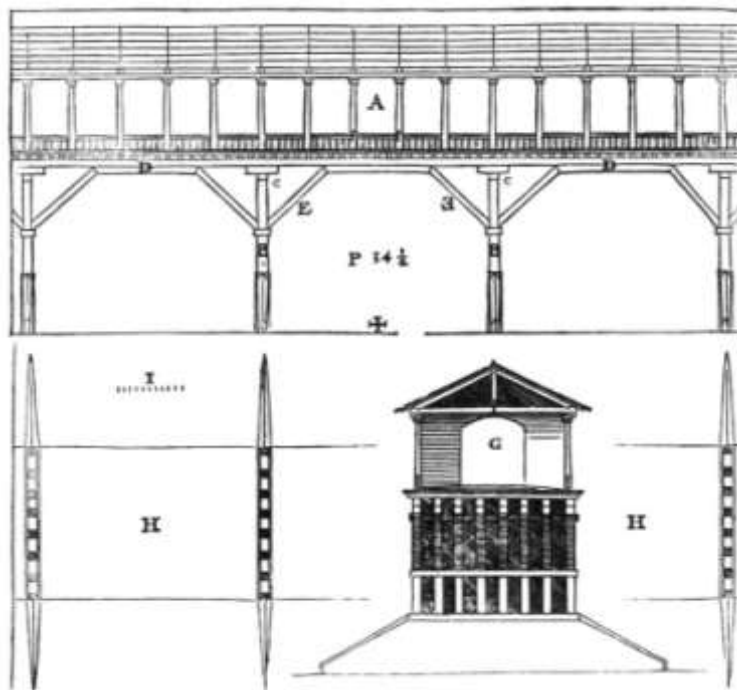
Ponte de madeira em Bassano del Grappa de 1567
